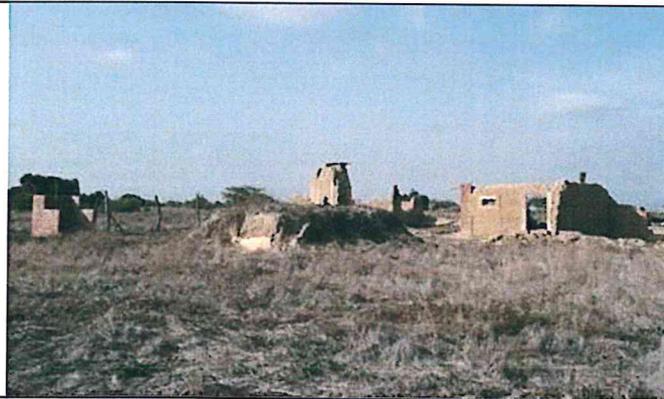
Viviendas de adobe, inhabilitada por el colapso de sus paredes y techo.
